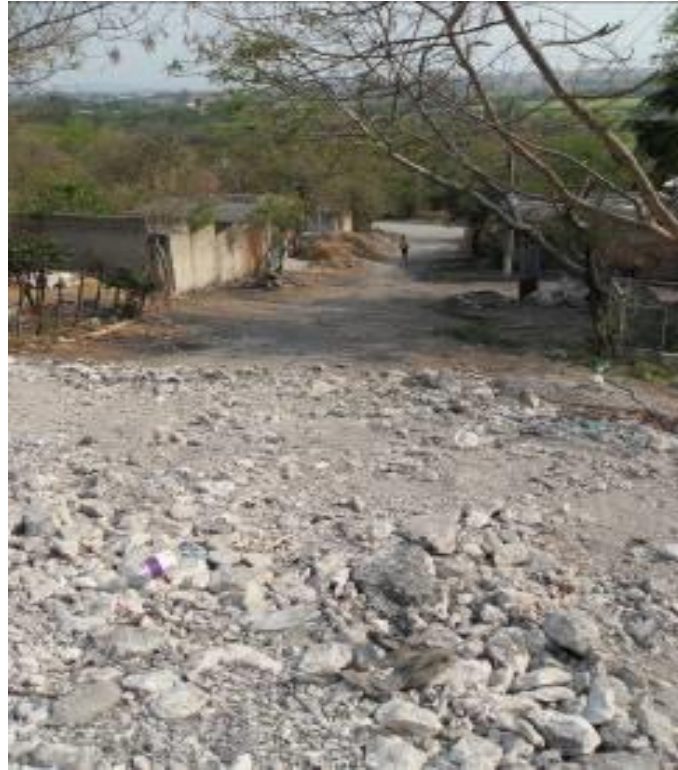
Calle Lauro Ortega, sin drenaje y pavimentación.
